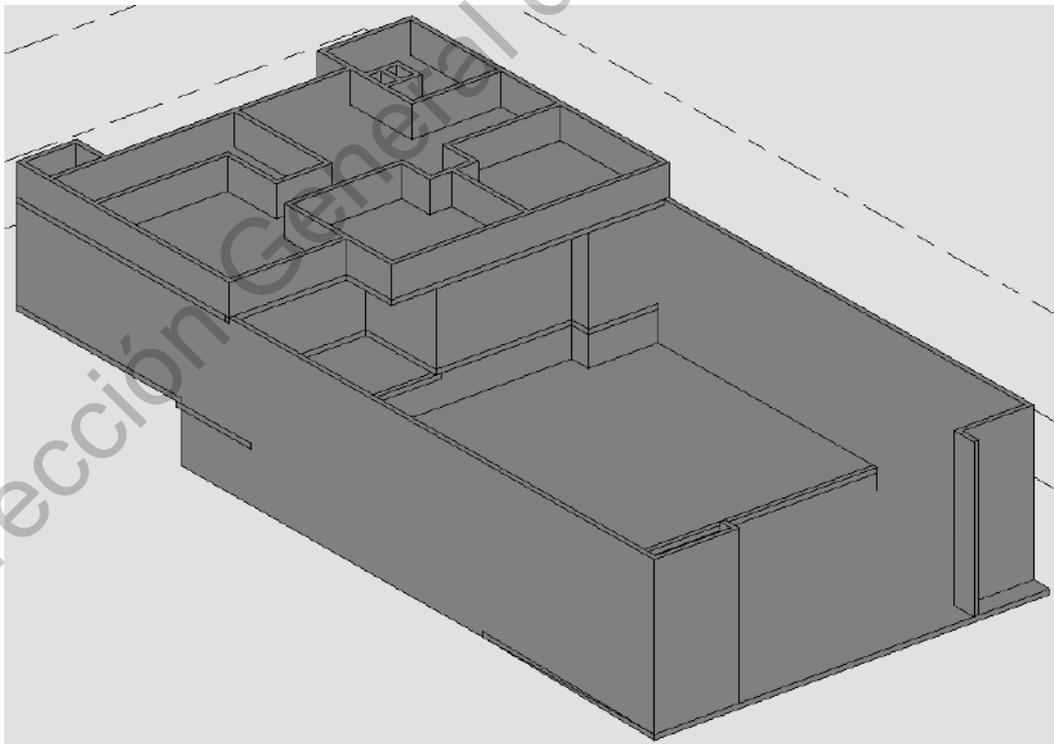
Suelos/Rampas de Planta alta del proyecto 002
